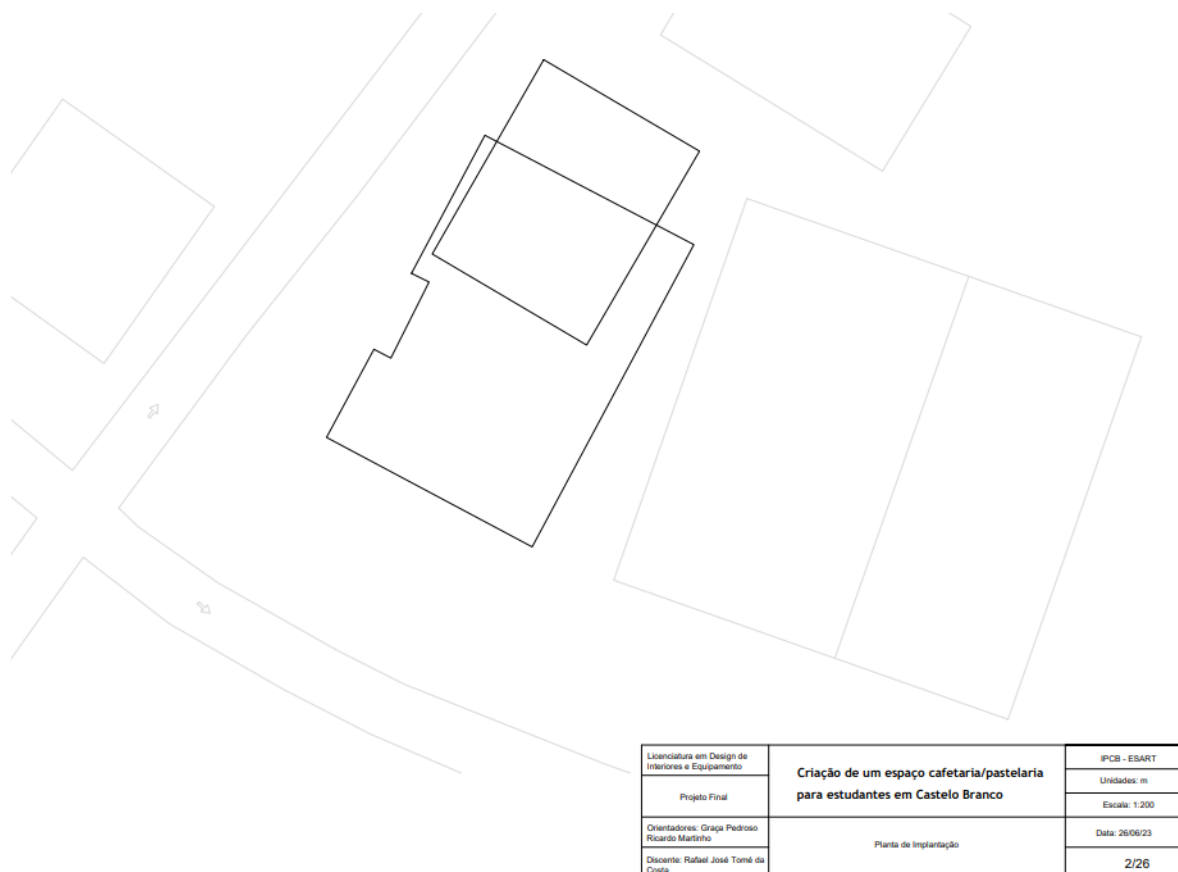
Planta de Implantação. Fonte: Rafael Costa
